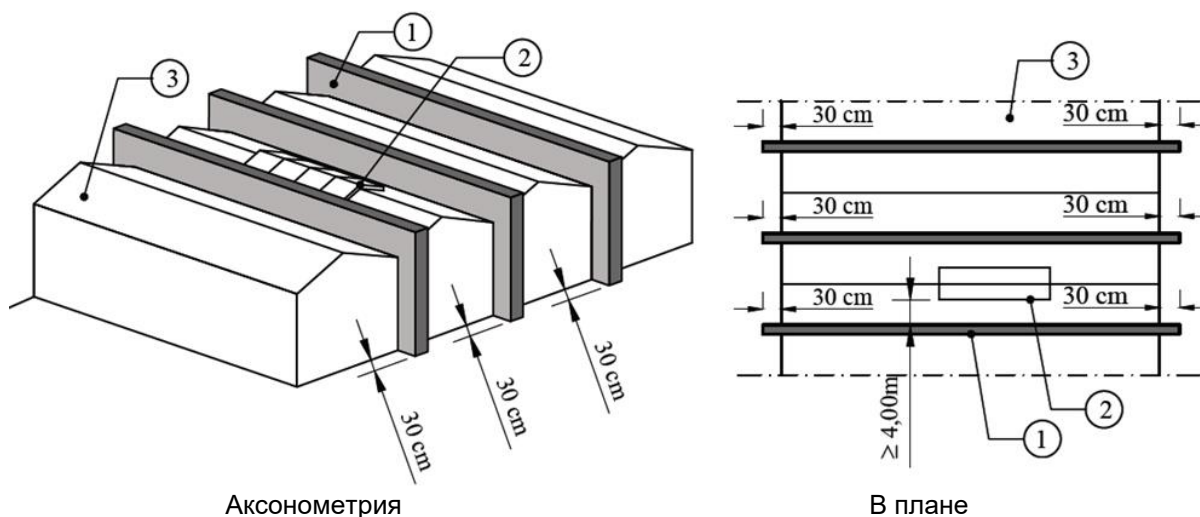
Пересечение наружных горючих конструкций кровли и стен
